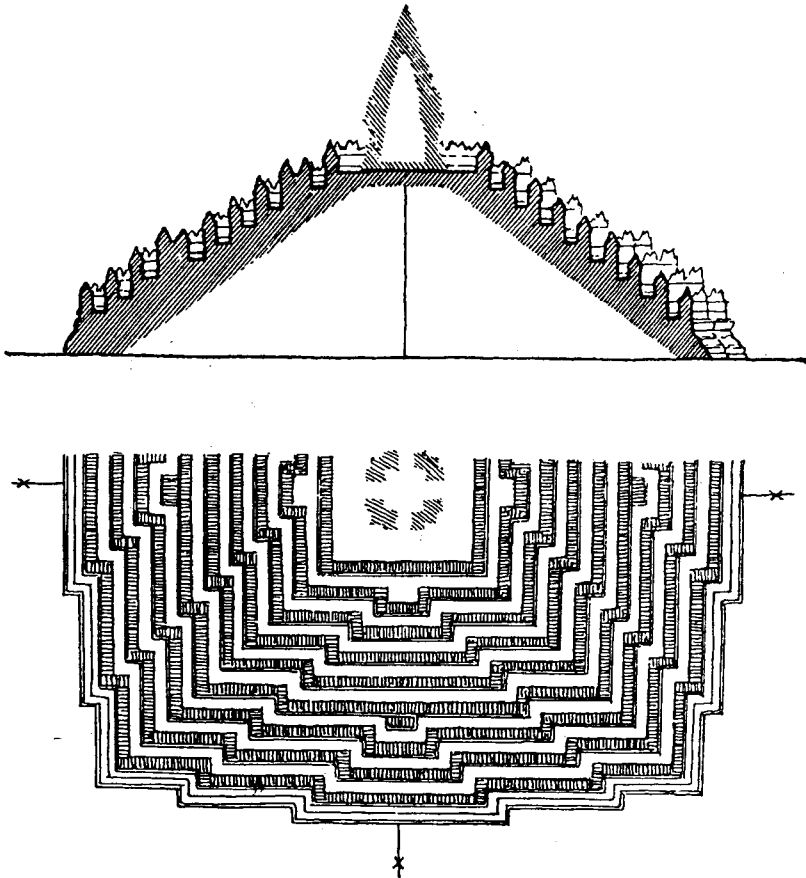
PLAN ET COUPE DU BARABUDUR PRIMITIF, selon M. A. HOENIG.
